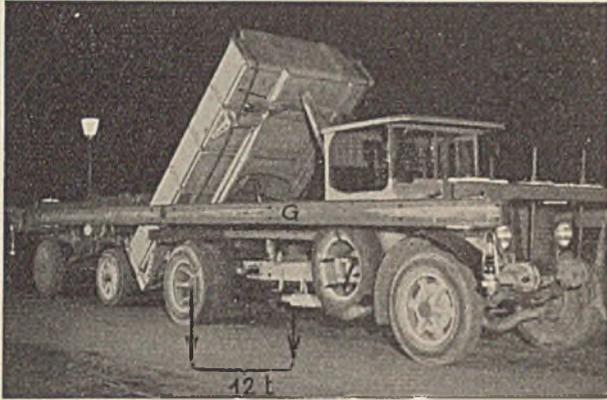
Der Einachs-Lastwagen zur Durchführung der statischen Messungen.
